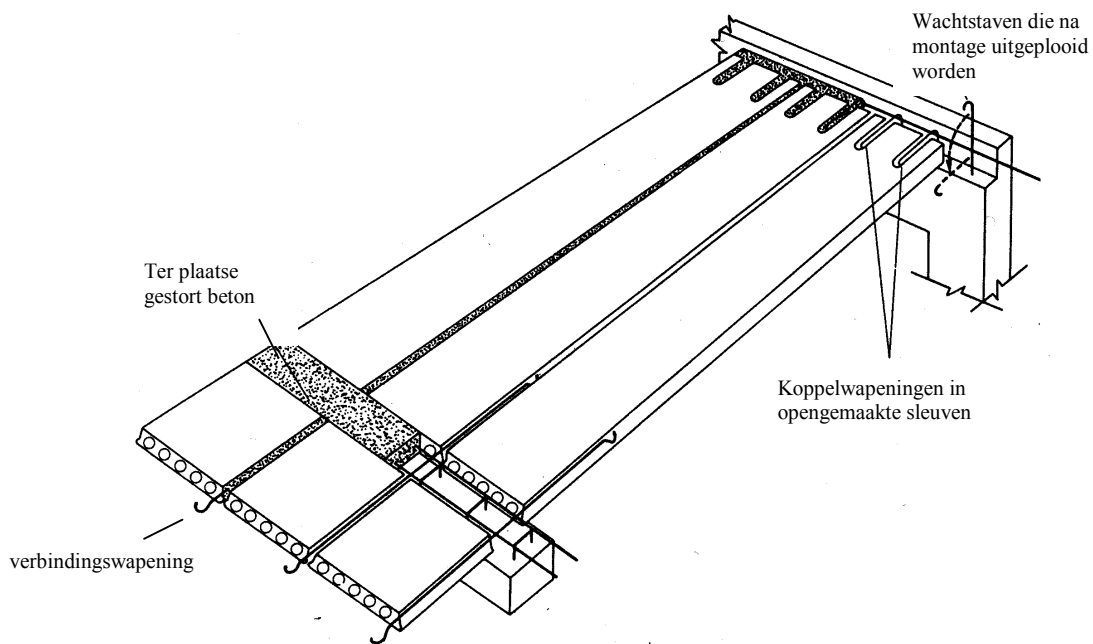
Trekverbindingen met wachtstaven en andere wapeningen
